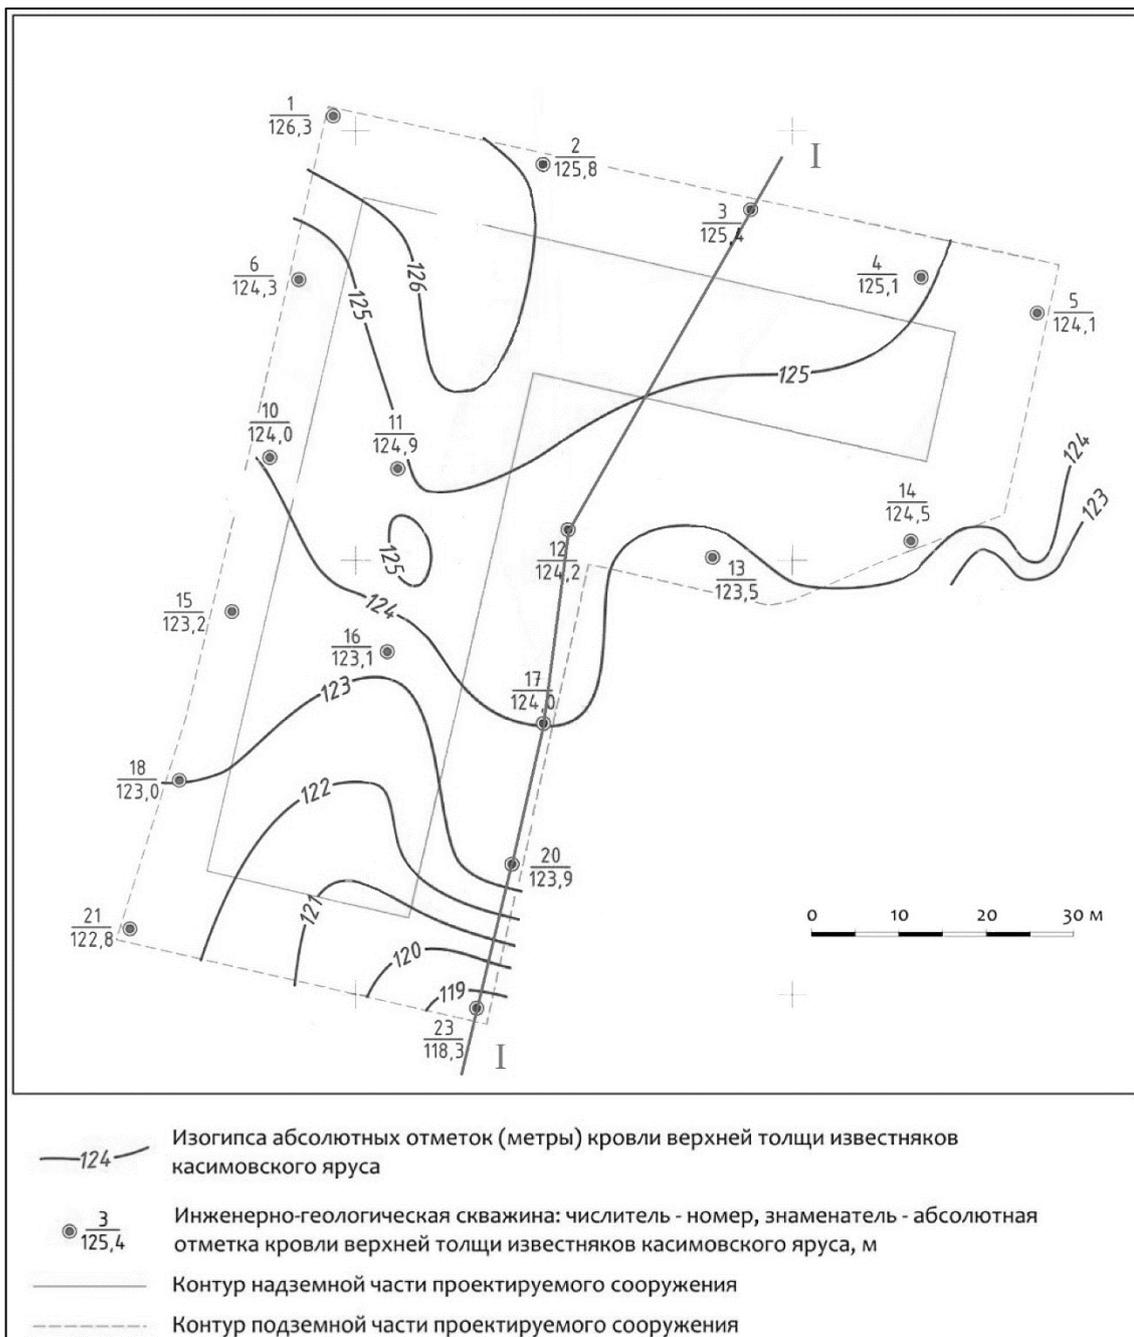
Карта кровли верхнекаменноугольных отложений.
